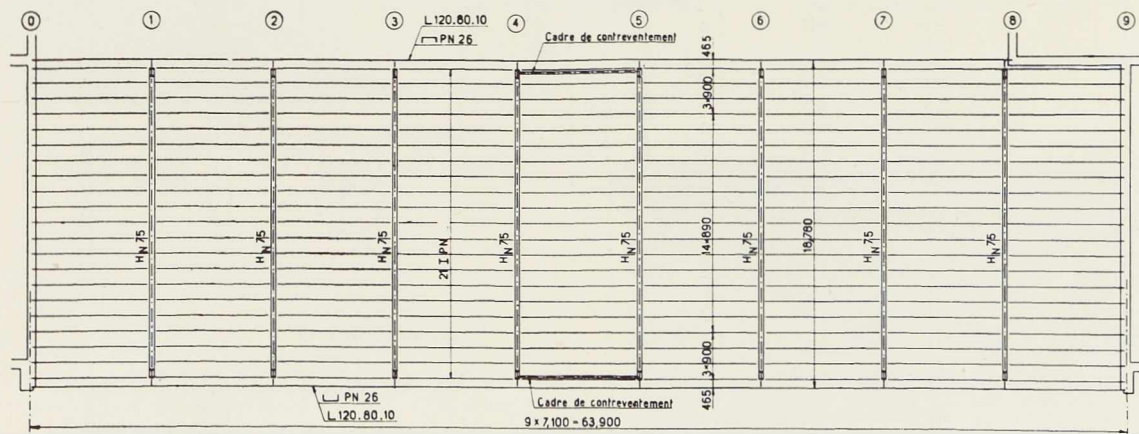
Vue en plan montrant les huit cadres en poutrelles à larges ailes ainsi que les deux contreventements reliant les portiques sans trous.
